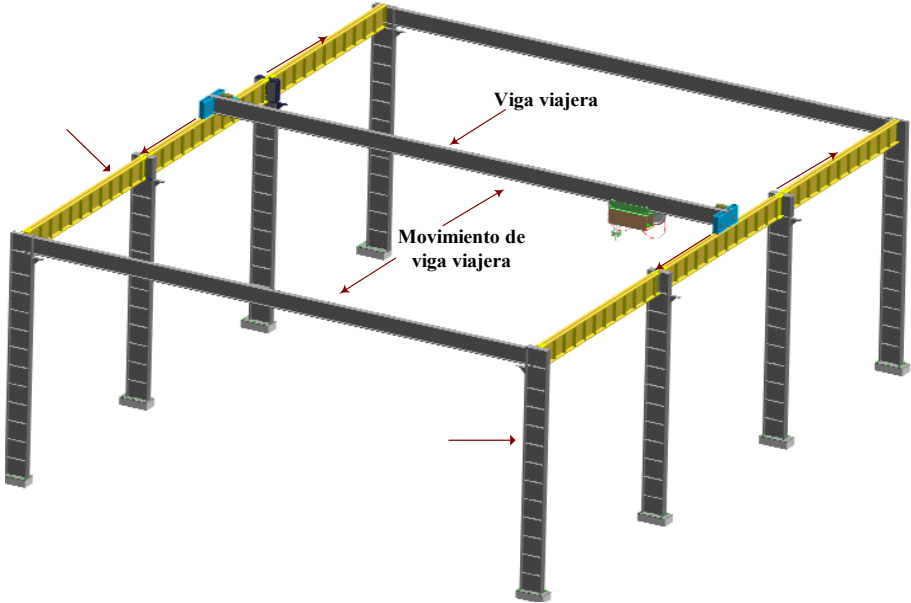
Marco estructural columnas-vigas de grúa puente
